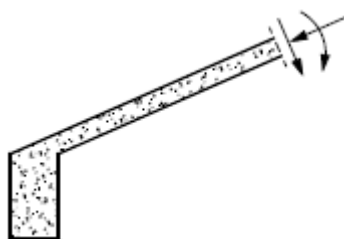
Apoio de uma laje inclinada numa viga de extremidade. [7]
